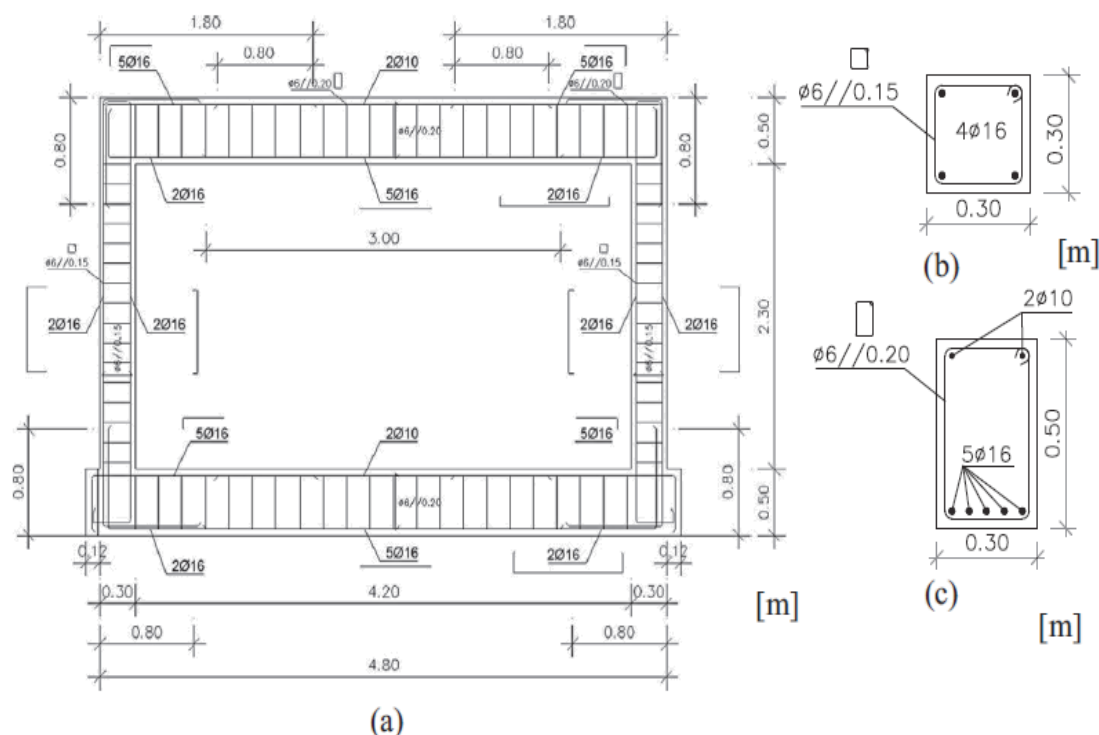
Dimensões e secções transversais do pórtico ensaiado: (a) dimensões gerais do pórtico, (b) secção transversal dos pilares e (c) secção transversal da viga [Fonte: (Furtado et al., 2016)].
